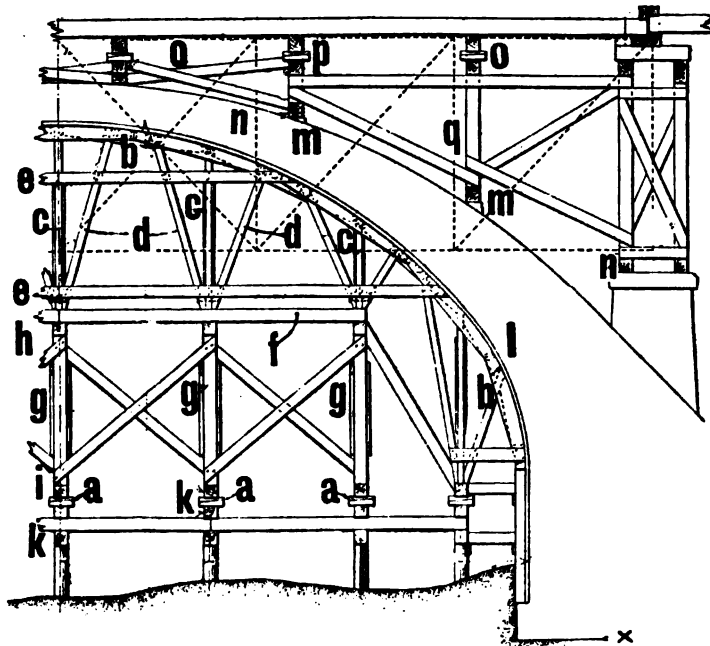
Stampfgerüst für einen größeren Brückenbogen.
